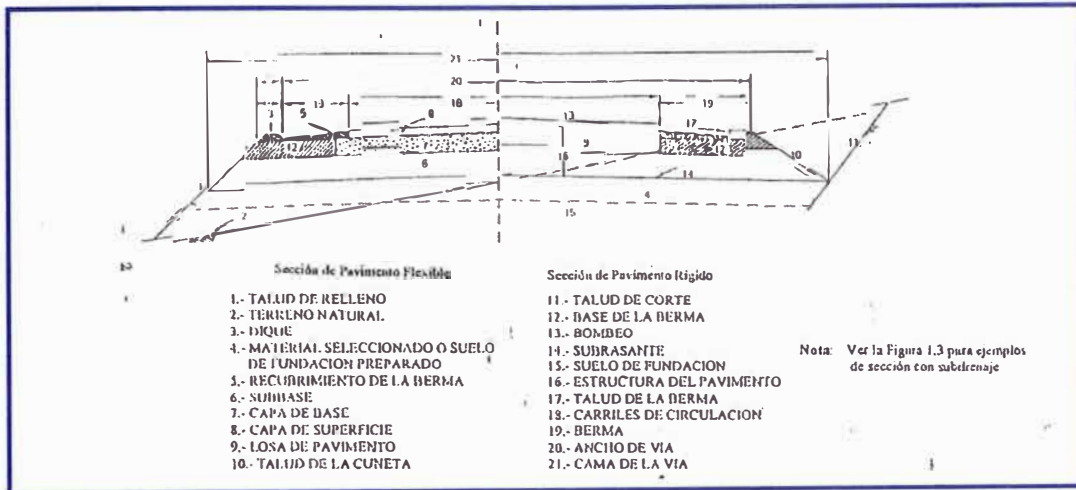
Secciones Típicas para Estructuras de pavimentos Flexibles o Rígidos.
